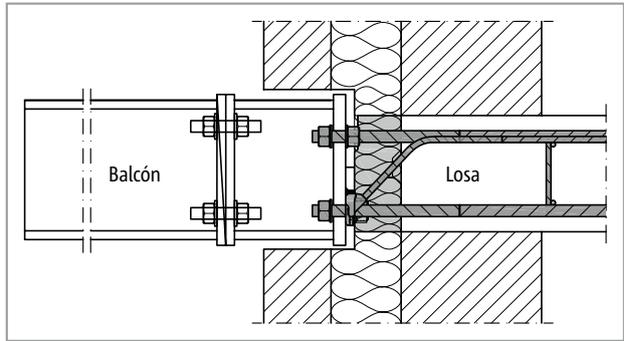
Schöck Isokorb® T tipo SK: Elemento aislante dentro del núcleo aislante; el conector in situ entre el Isokorb® y el balcón proporciona flexibilidad en el proceso de construcción
